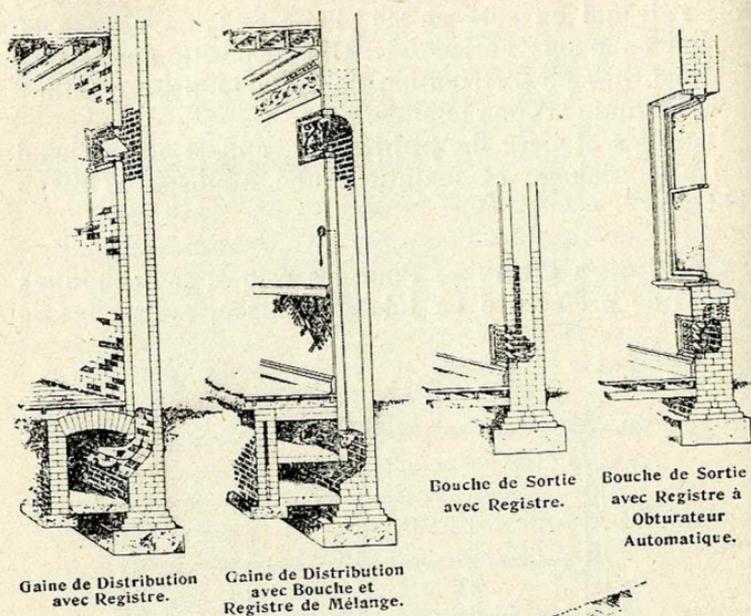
Conduites d'air en souterrain et dans les murs, détails de construction.
